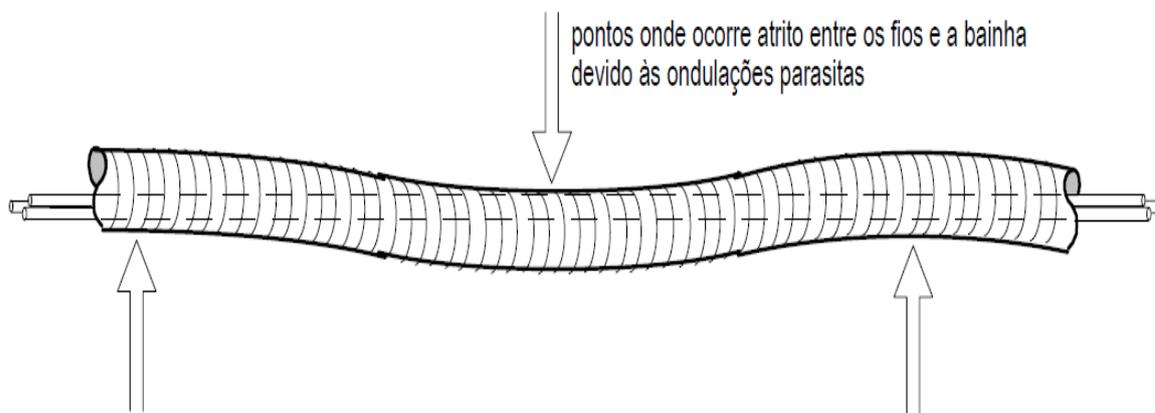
Corte em bainha metálica demonstrando pontos de atrito entre cabos e a própria bainha.
